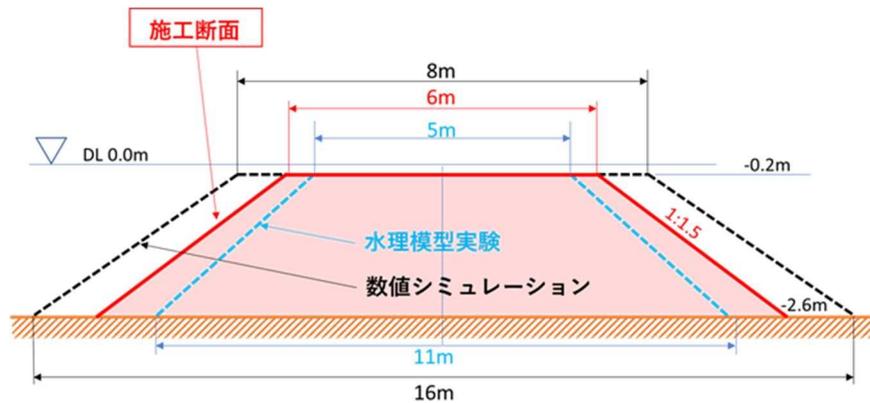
(7) 潜堤の施工断面(潜堤先端位置)
